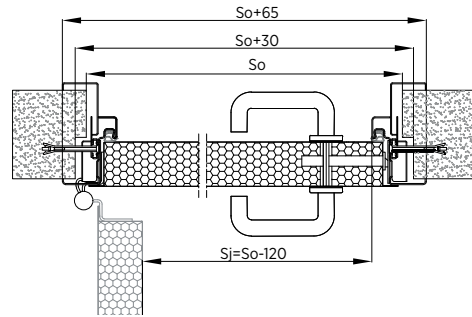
Pose au mur - porte à un vantail - bâti enveloppant à rupture de pont thermique - coupe horizontale.
